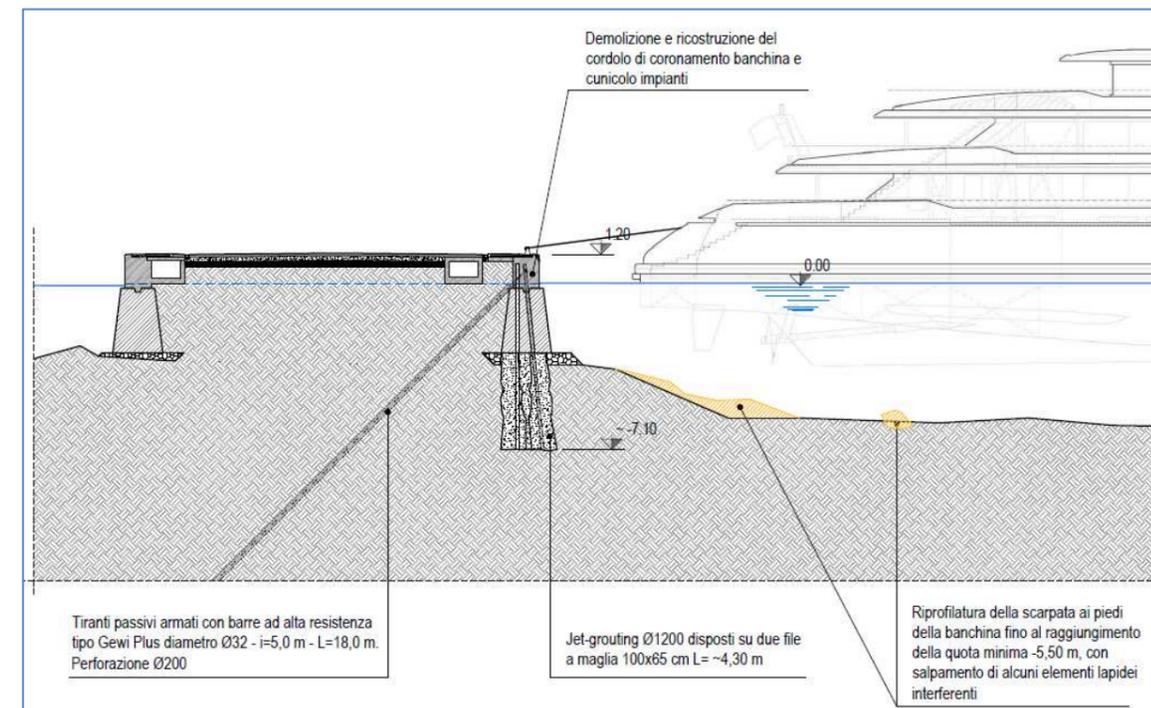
Sezione tipo rinforzo banchina Molo Langano
